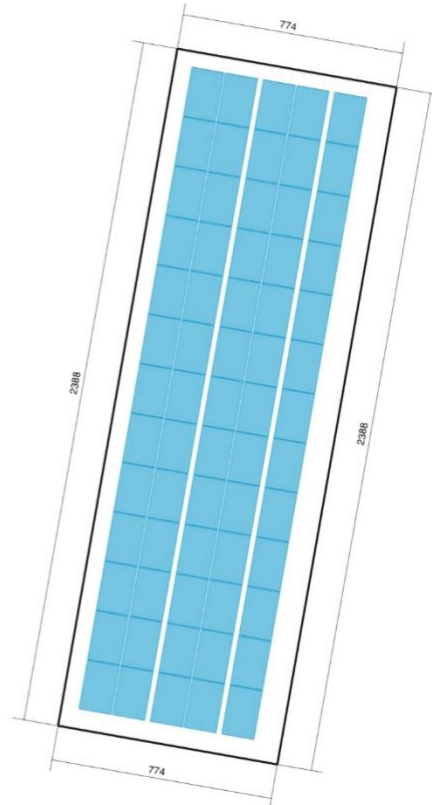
Bürgerfeldstrasse 2.1, Belegungsplan, Dachfläche 1
